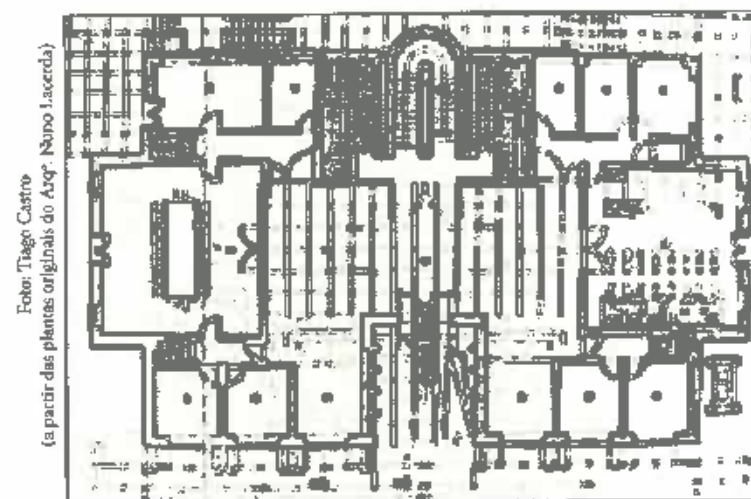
Planta do piso 3: Entrada principal, Serviços Administrativos, Junta de Freguesia, cafetaria, salas de apoio e posto de turismo – Projecto de Reconstrução da autoria do Arq<sup>o</sup>. Nuno Lacerda Lopes (1997).
